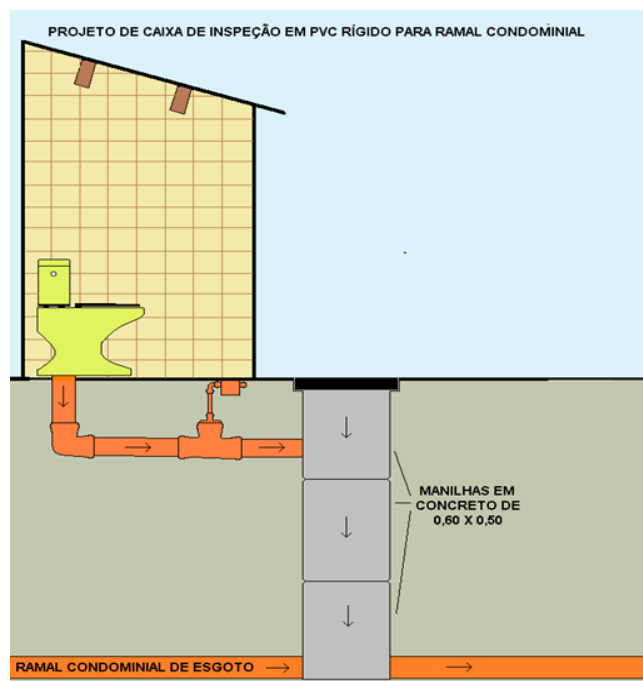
Situação atual das ligações de esgoto condominiais com malhas em concreto
